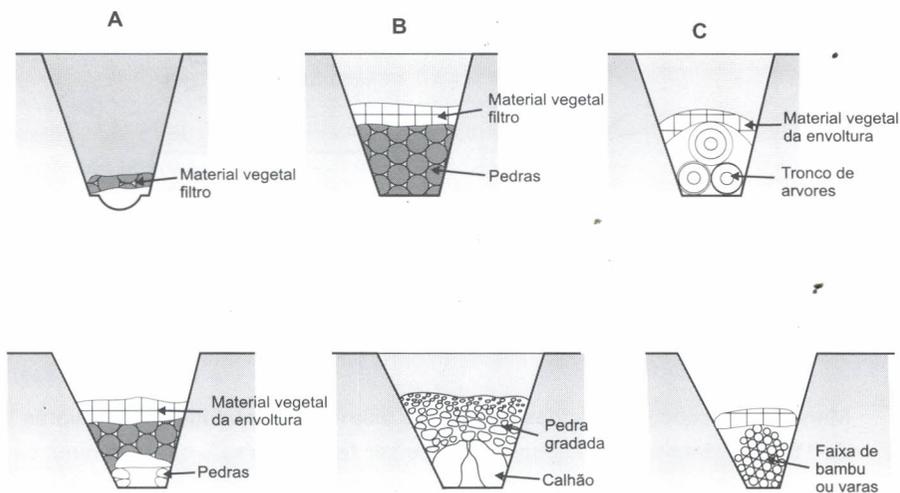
Materiais alternativos na instalação de drenos enterrados (A, B, C, D, E e F).
